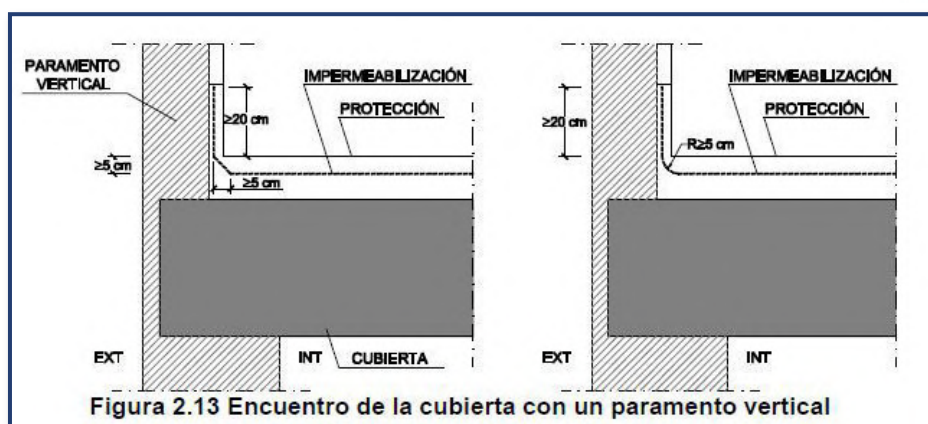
Encuentros de la cubierta con un paramento vertical.
